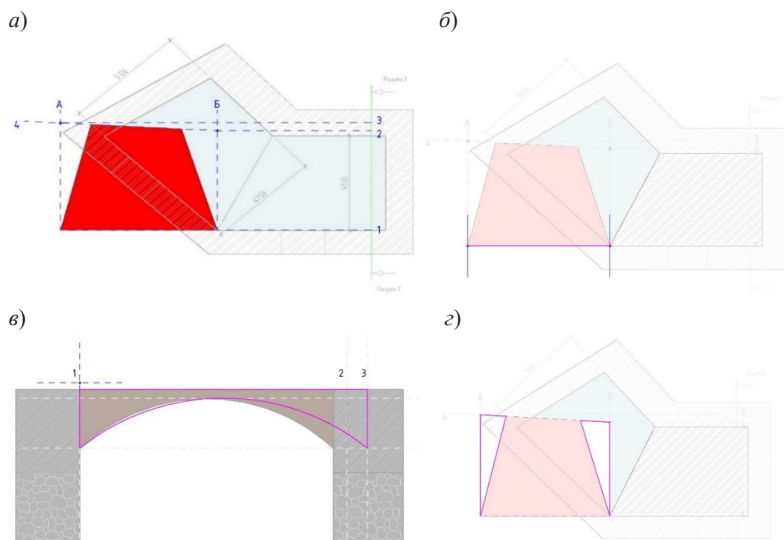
Этапы создания левого сегмента сводчатого перекрытия:
